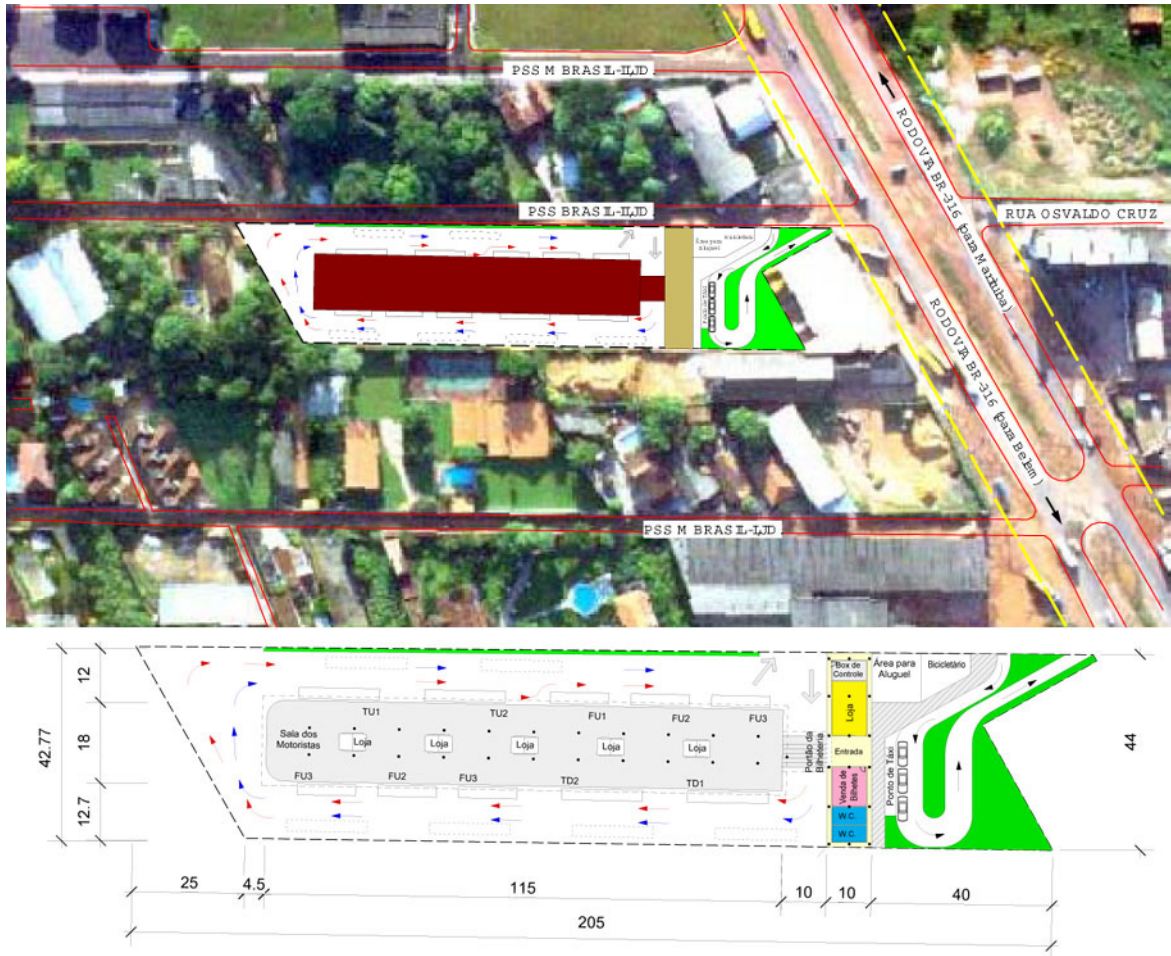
Localização e Planta do Terminal E: Águas Lindas (sem escala)
